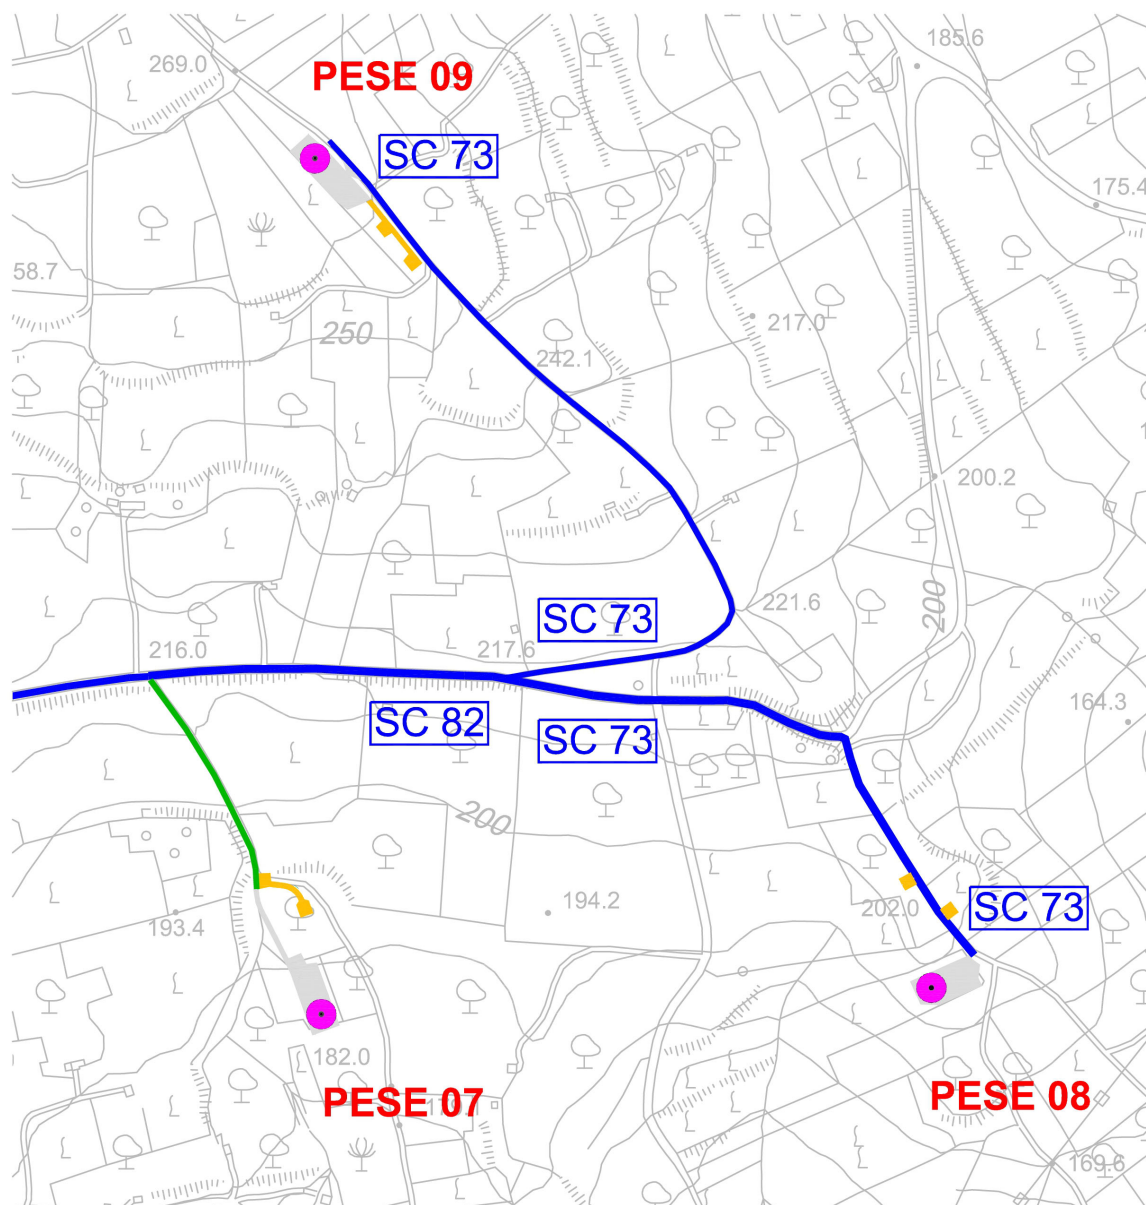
Planimetria delle strade di cantiere scala 1:5.000
